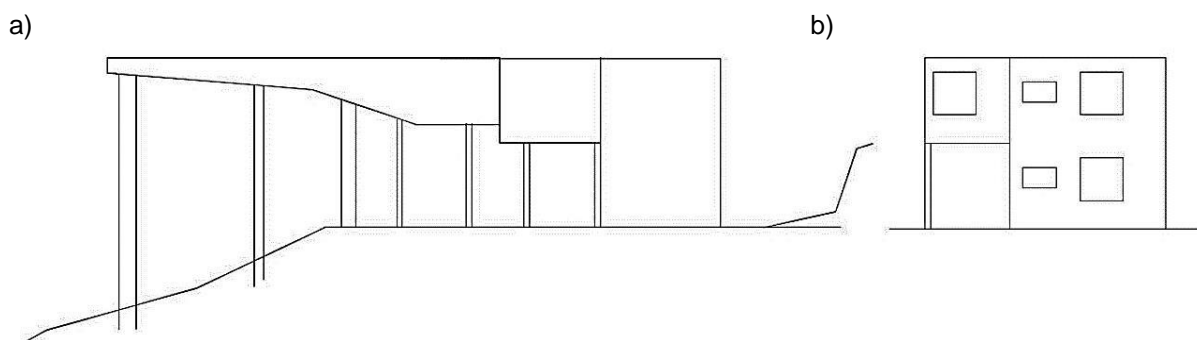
Primeiras elevações feitas em AutoCAD pelo arquiteto 1
